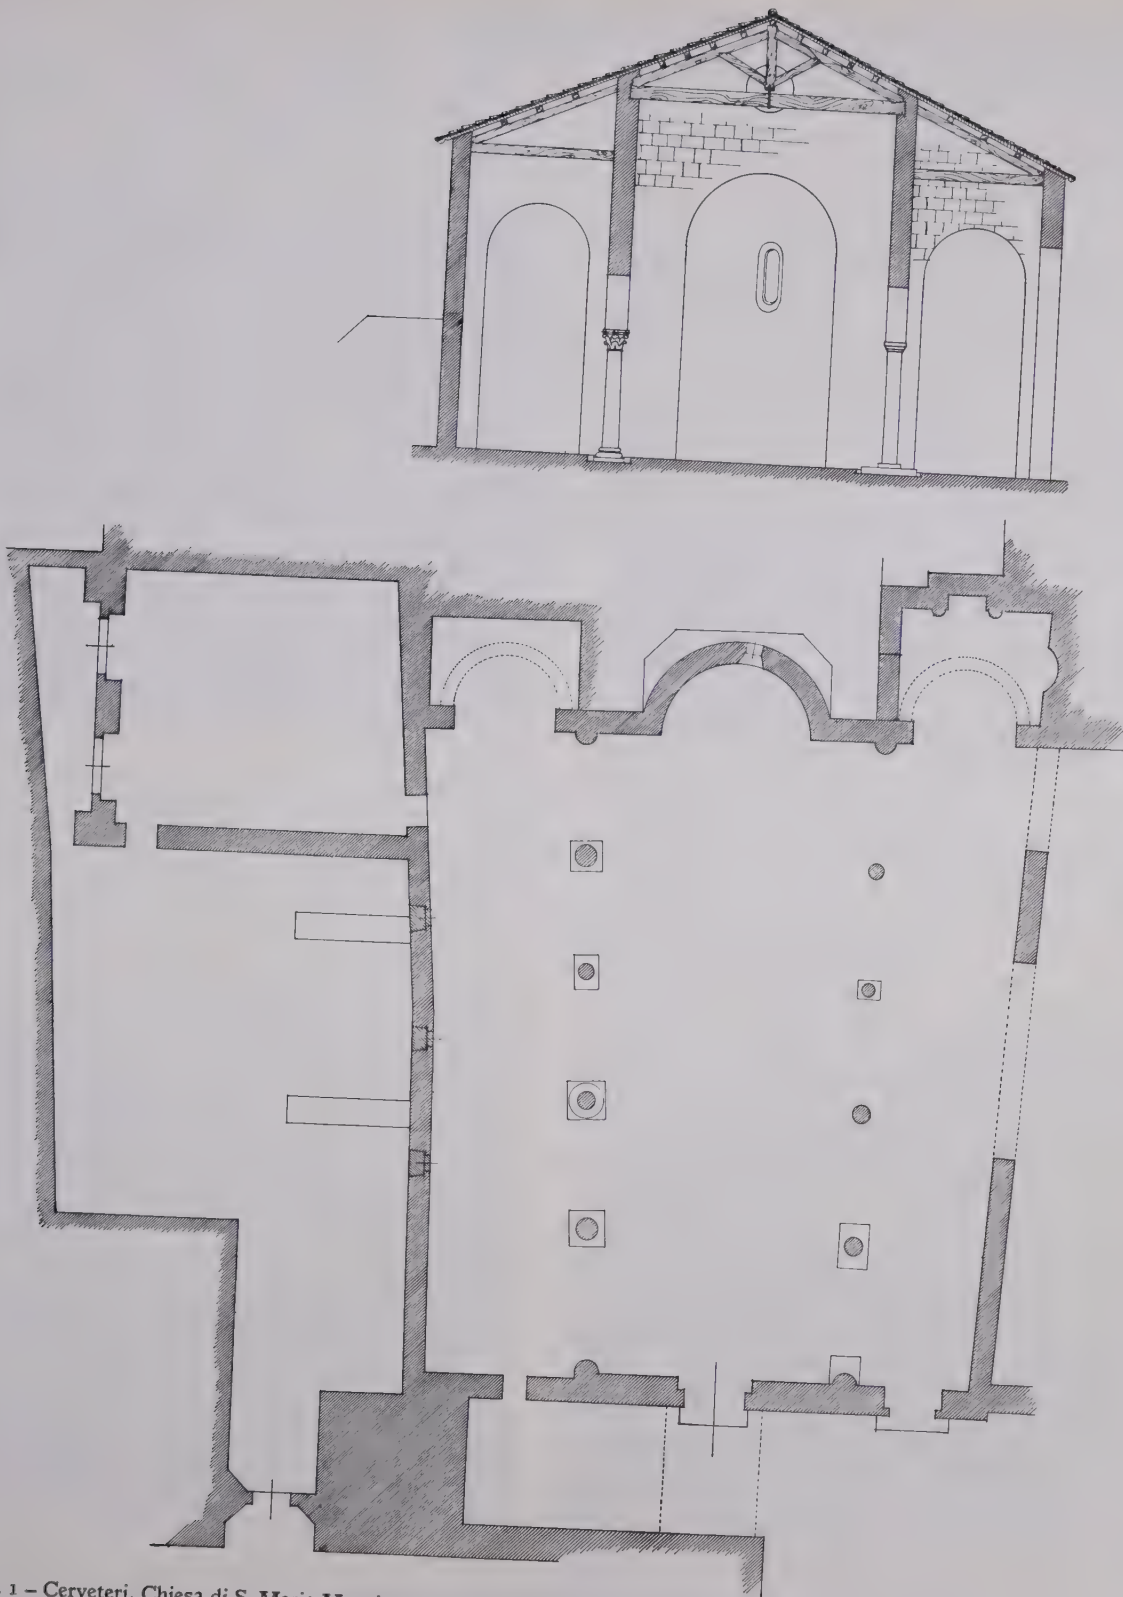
Cerveteri, Chiesa di S. Maria Maggiore. Pianta e sezione trasversale. Rilievo eseguito durante i lavori di restauro
